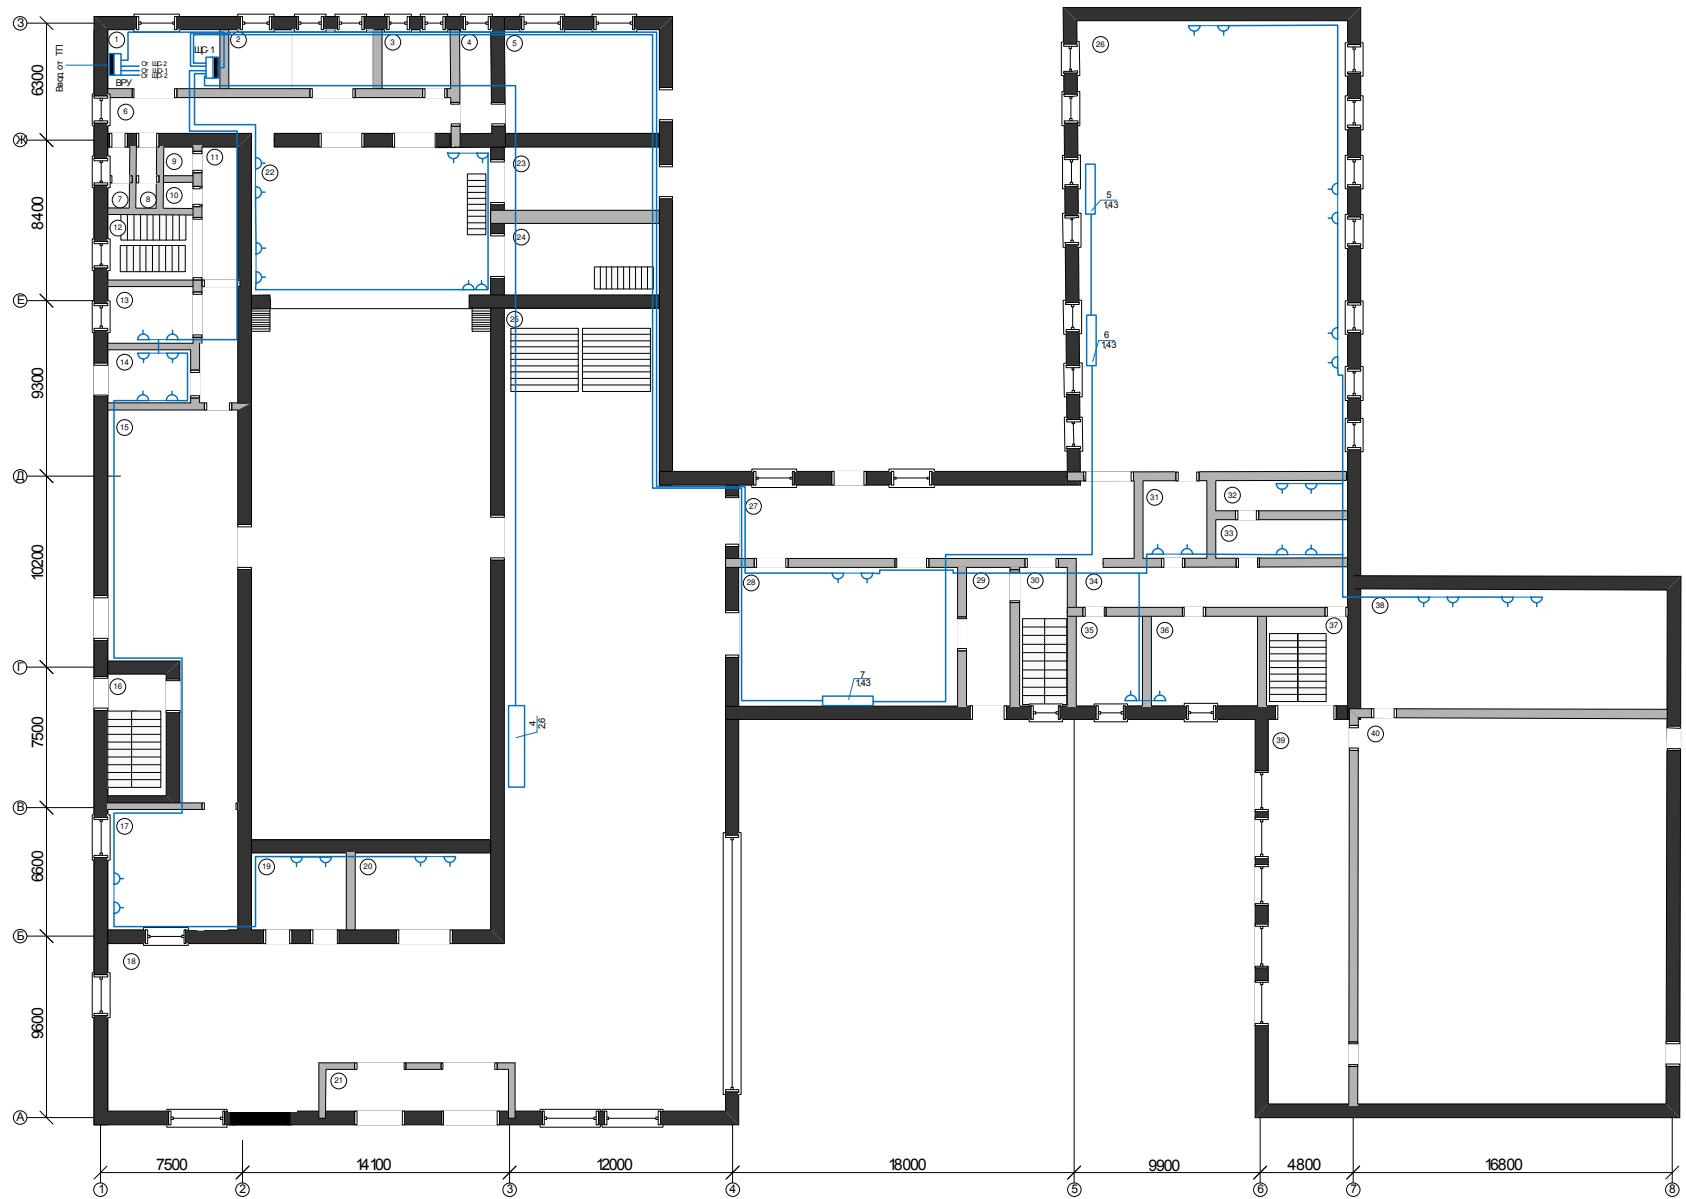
План 1-го этажа здания ЦКиД с силовыми сетями
